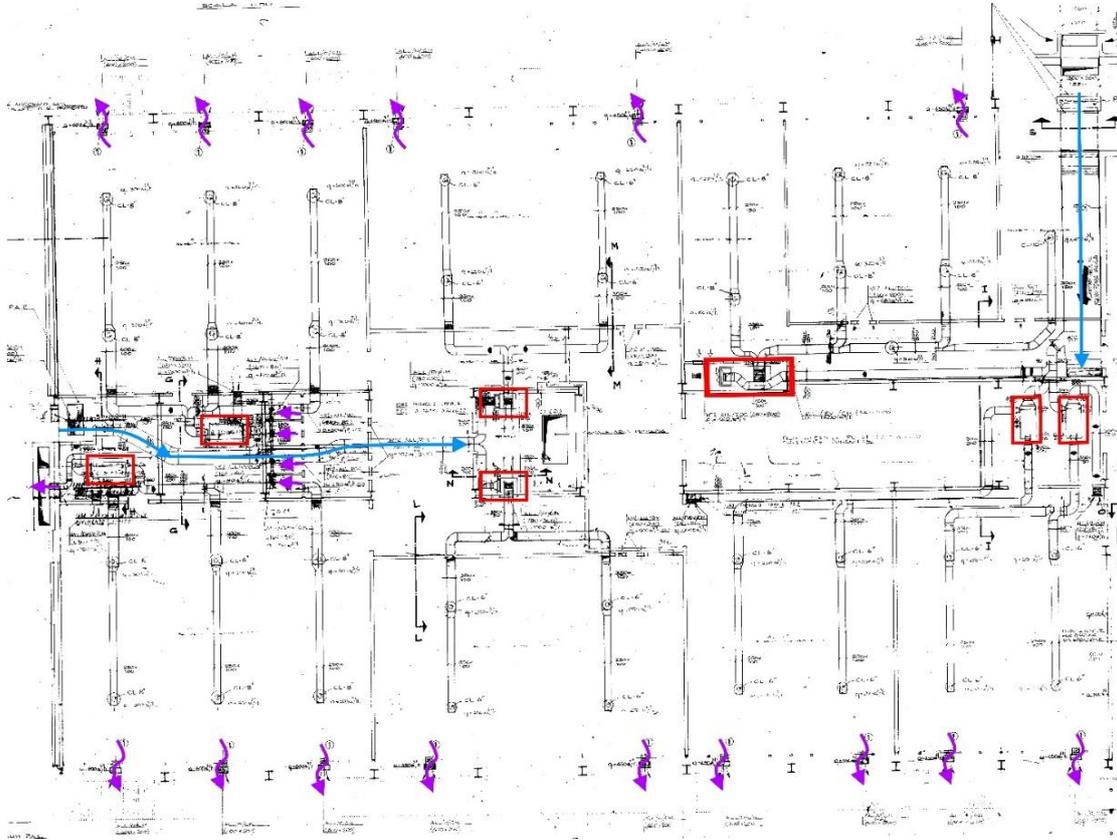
Impianto di termoventilazione di un piano piano Rialzato Corpo Scientifico Nord
